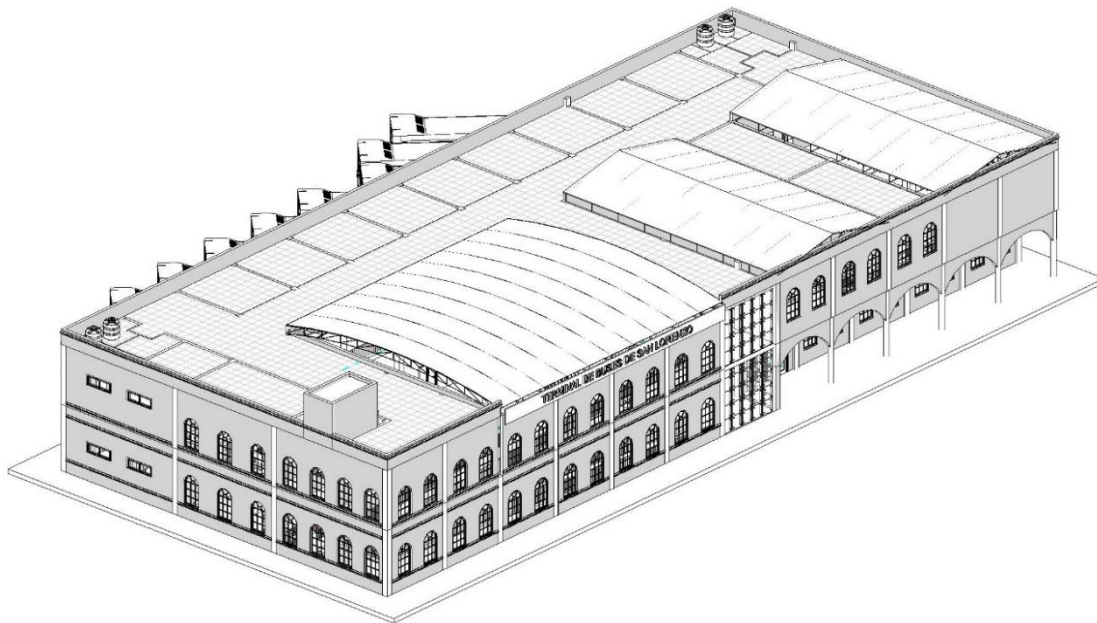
Vista en perspectiva de la estructura (fuente: plano arquitectónico)
